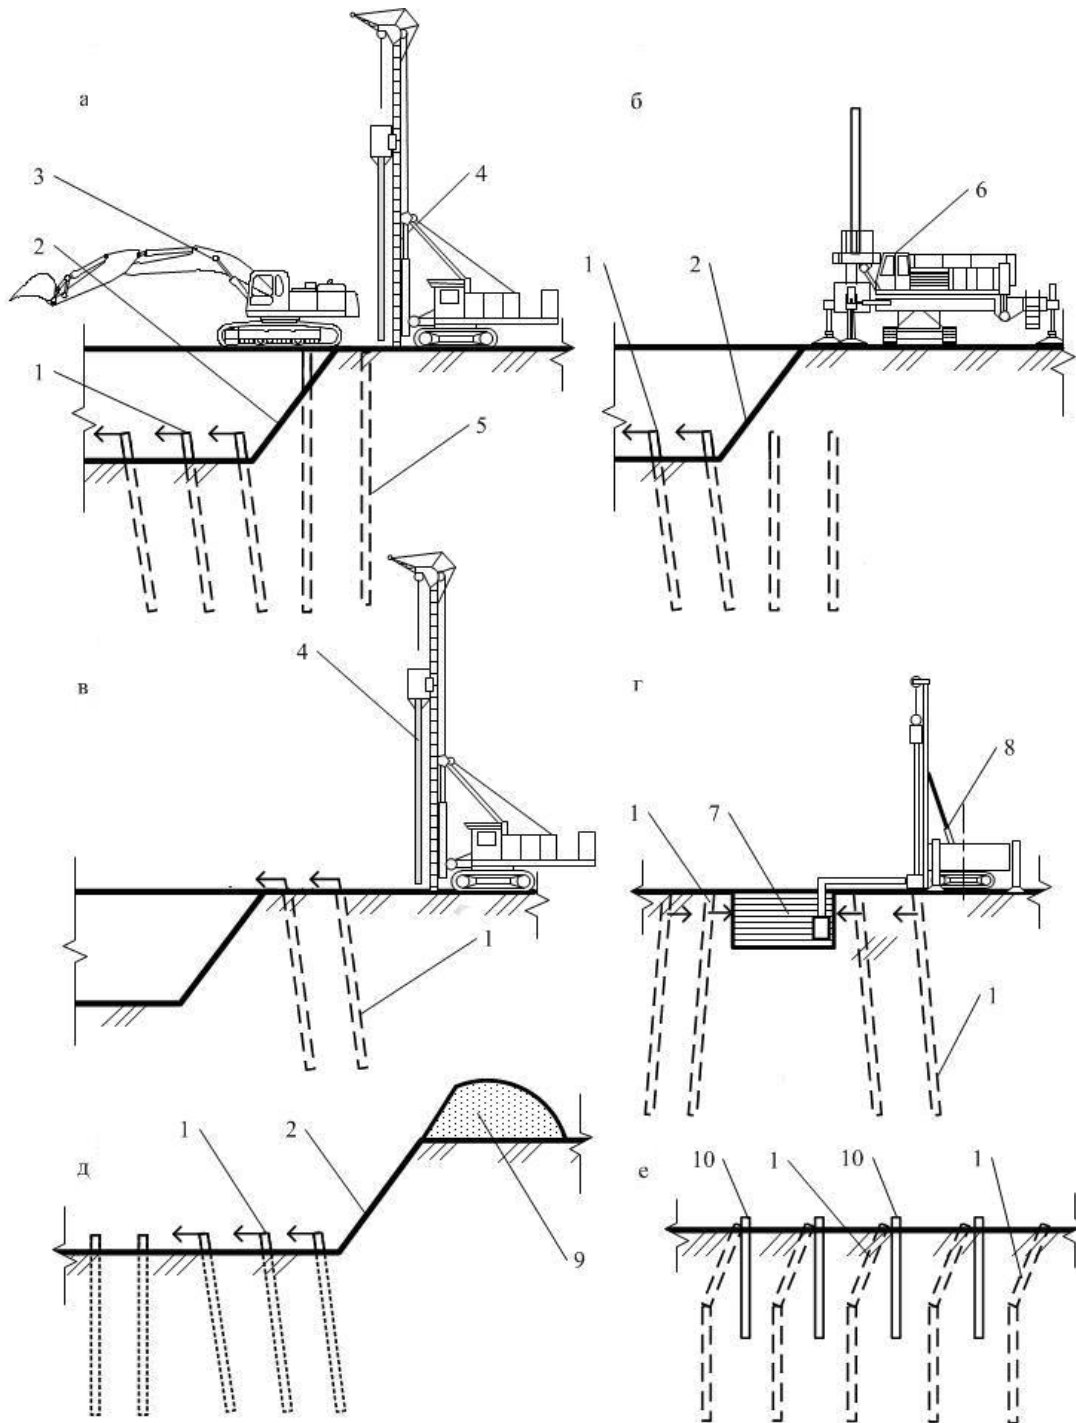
Схемы характерных случаев смещения свай под действием бокового давления грунта (а–д) и схема погружения дублирующих свай (е): а, в – при совмещении работ по разработке котлована и устройству свай с поверхности грунта; б – то же при вдавливании и последующем допогружении свай до проектного уровня; г – при наличии приямка (зумпфа) для сбора глинистого раствора; д – при дополнительных технологических нагрузках на уровне бровки котлована. Условные обозначения: 1 – смещенная свая (стрелка указывает направление смещения); 2 – откос котлована; 3 – экскаватор; 4 – буровая установка; 5 – свая, погружаемая с поверхности грунта; б – установка вдавливания; 7 – приямок для глинистого раствора; 8 – буровая установка для устройства свай под глинистым раствором; 9 – участок складирования грунта или строительных материалов; 10 – дублирующая свая
